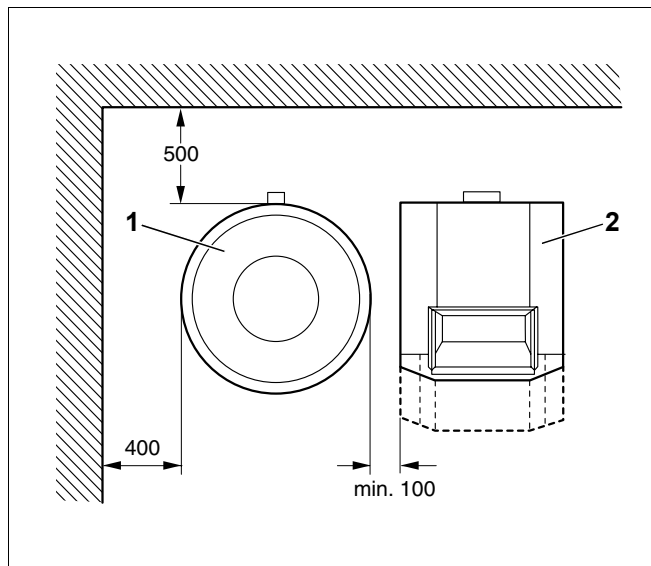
Distanțe minime pentru montaj și întreținere (cote în mm)
